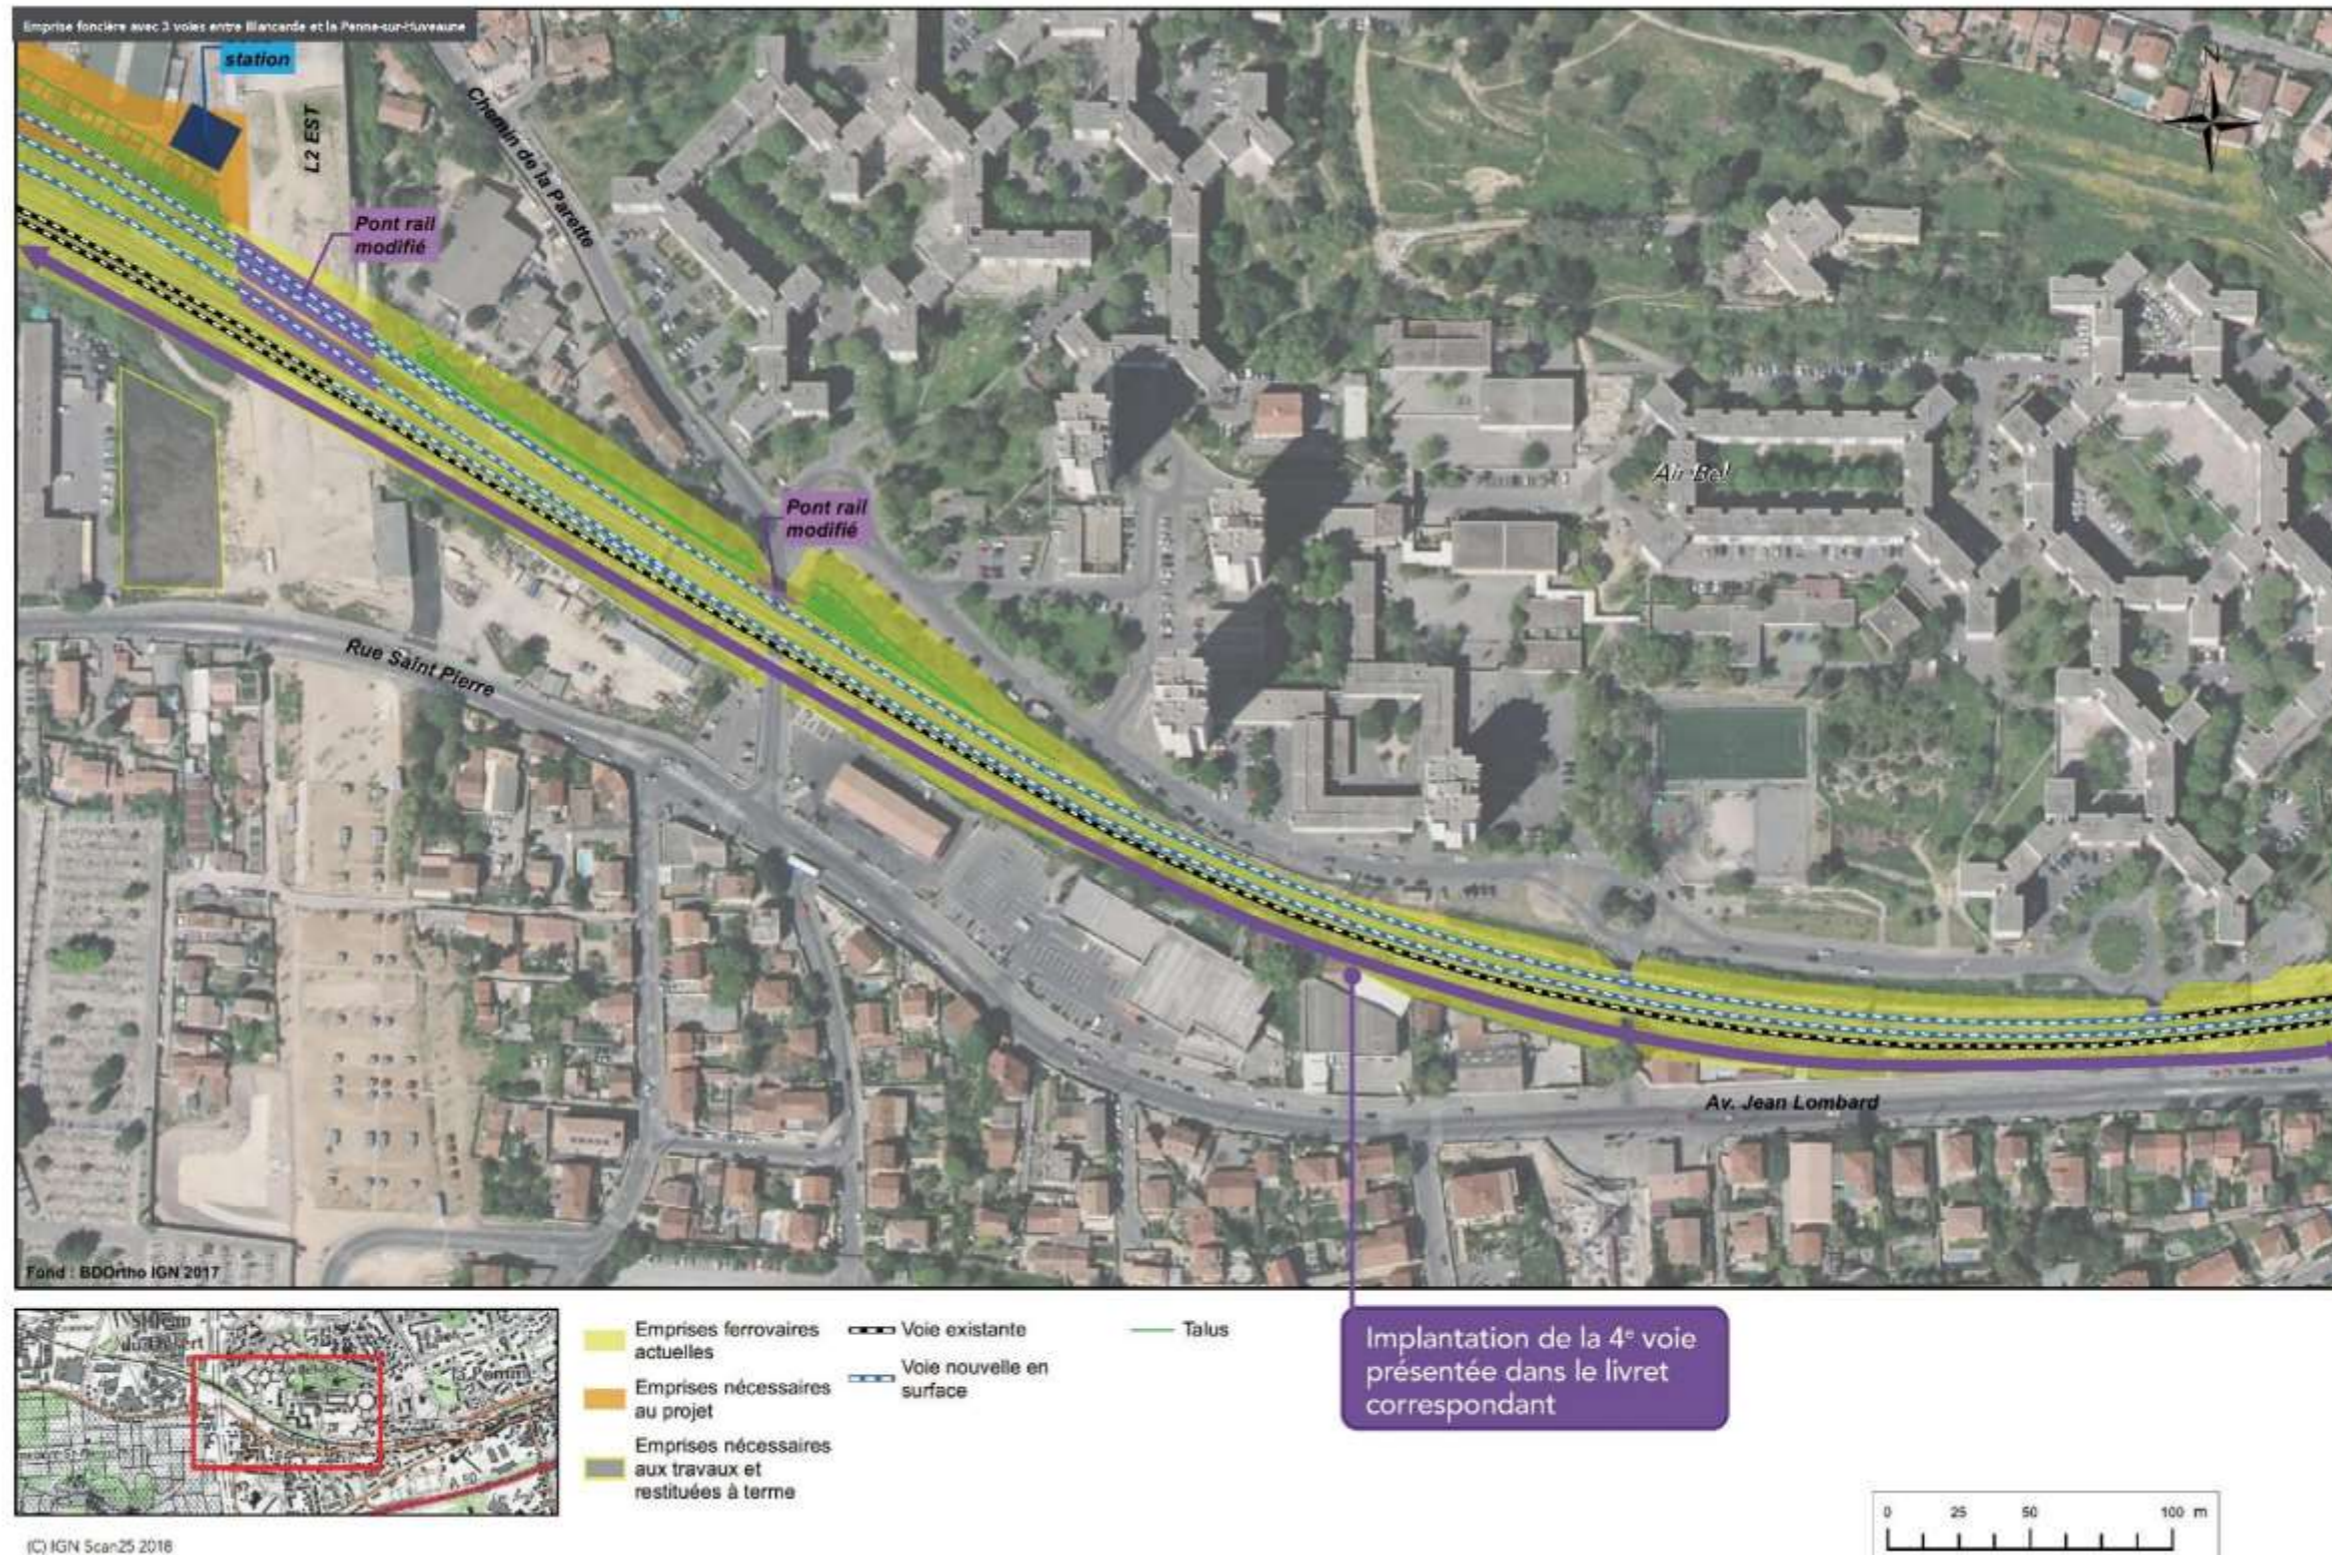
Plan de la solution d'entrée est du tunnel à la Parette 2/2 (dossier de concertation 2021)
